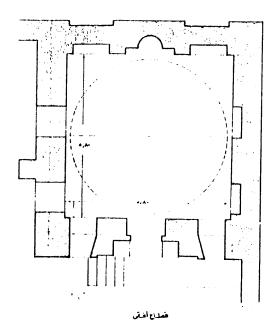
مسقط أفقى لقبة السبع بنات عن هيئة الآثار
